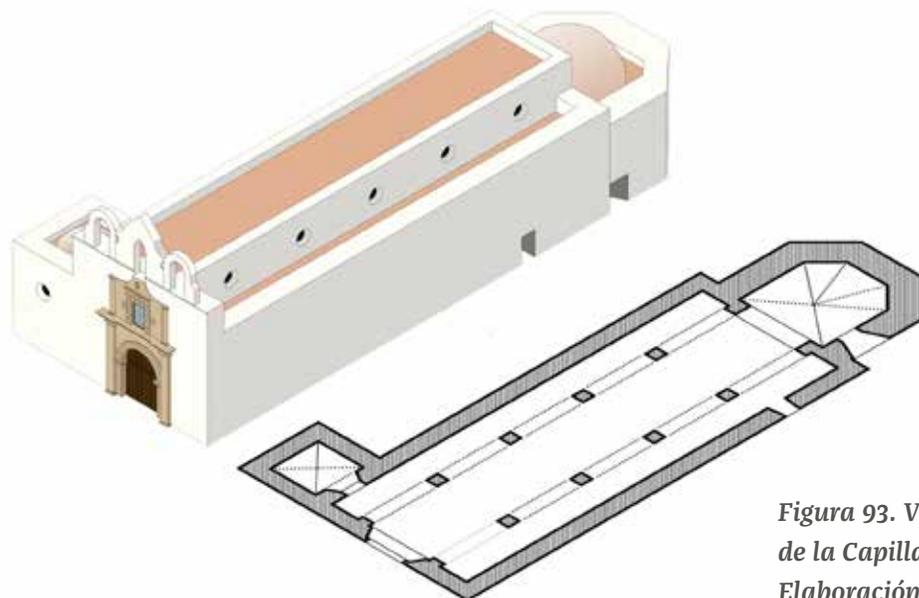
Vista isométrica con planta de la Capilla de Santa Anita. Fuente: Elaboración propia, 2016.
